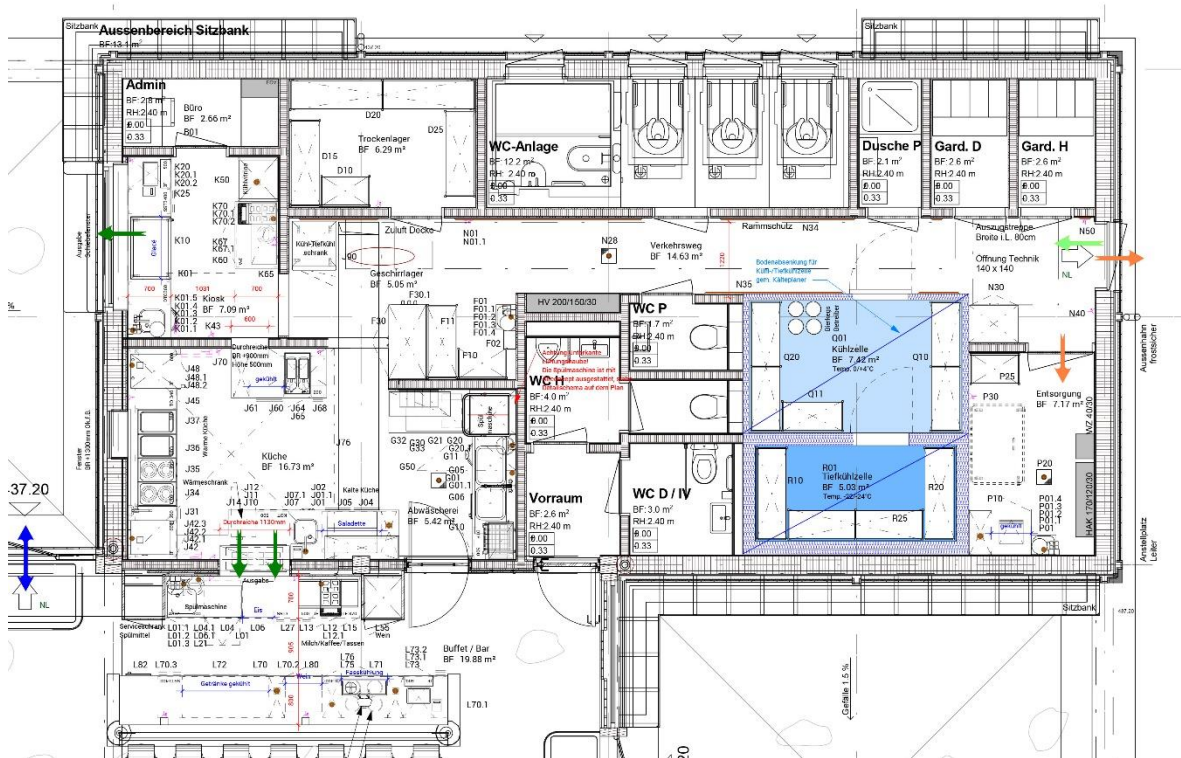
Grundrissplan Küche/rückwärtiger Bereich des Seerestaurants
